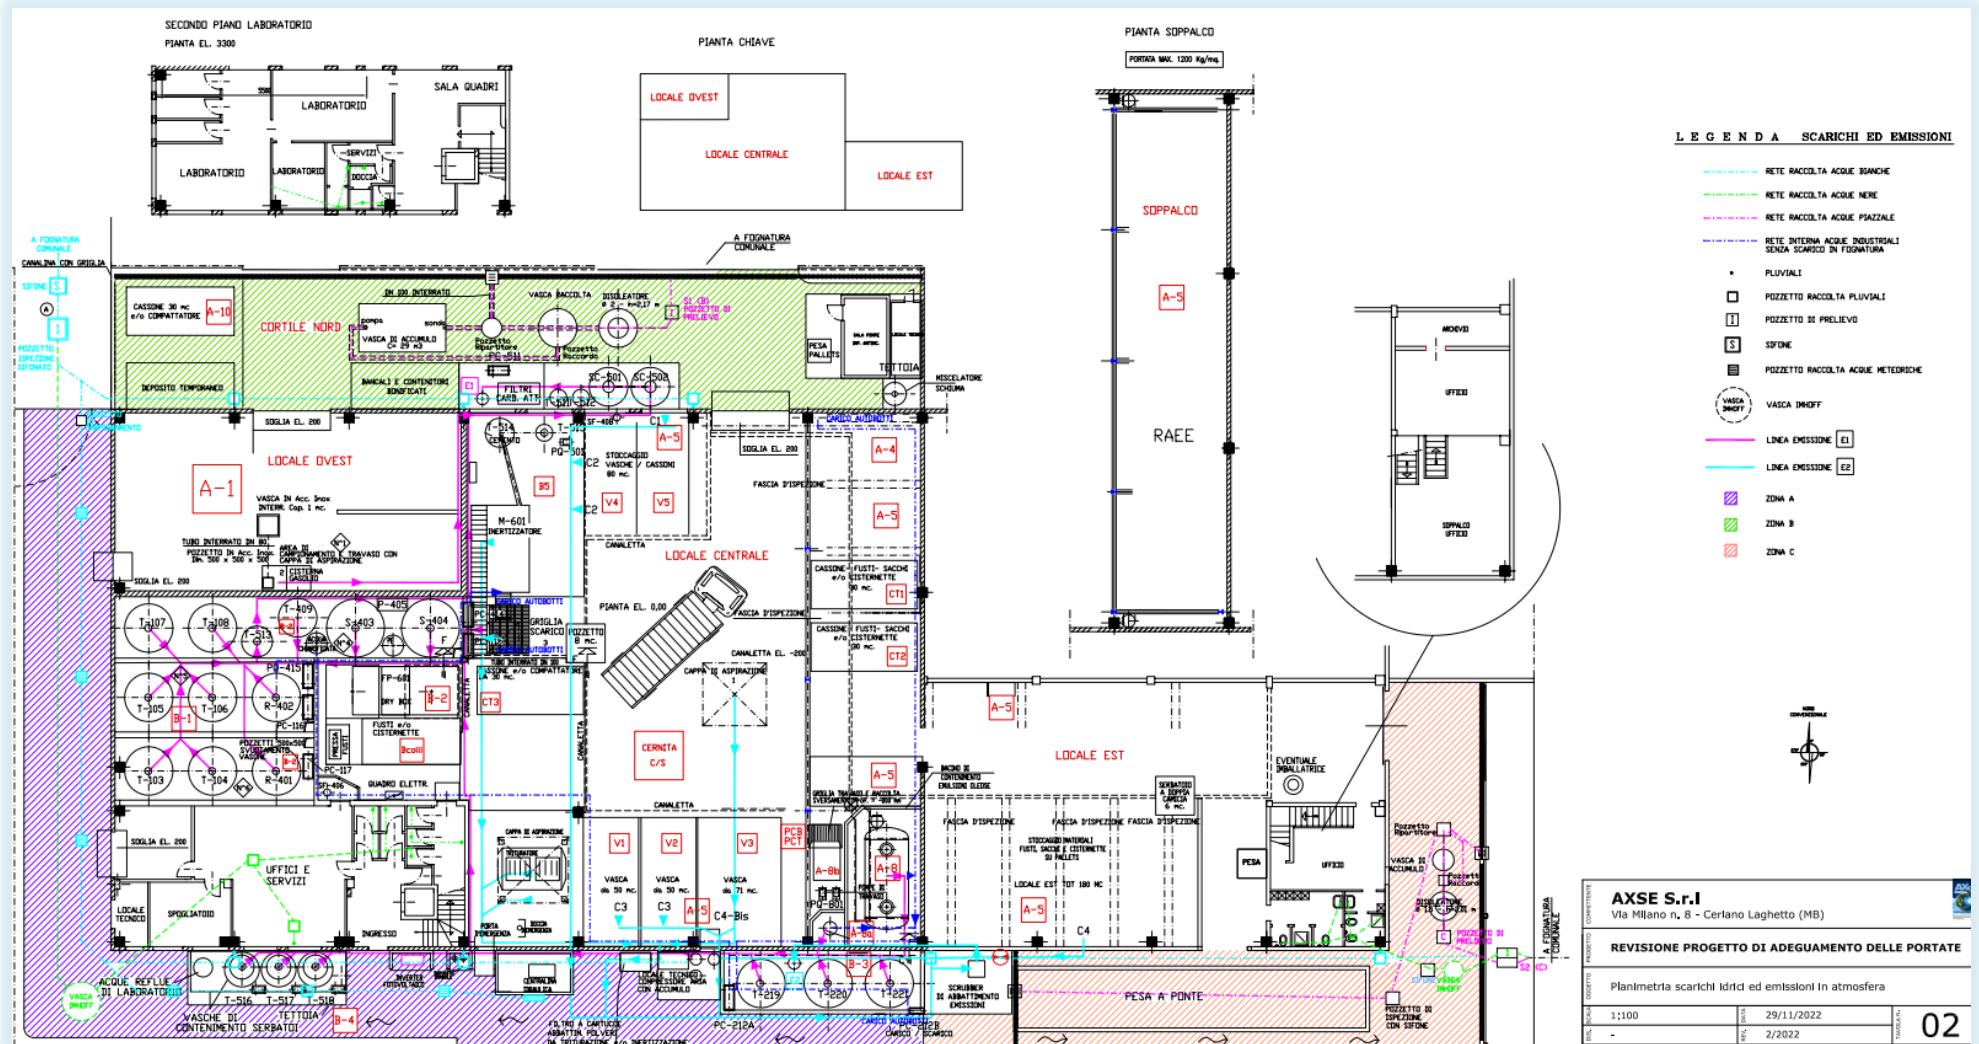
Planimetria generale AXSE di Ceriano Laghetto (MB) con indicazione degli scarichi idrici
